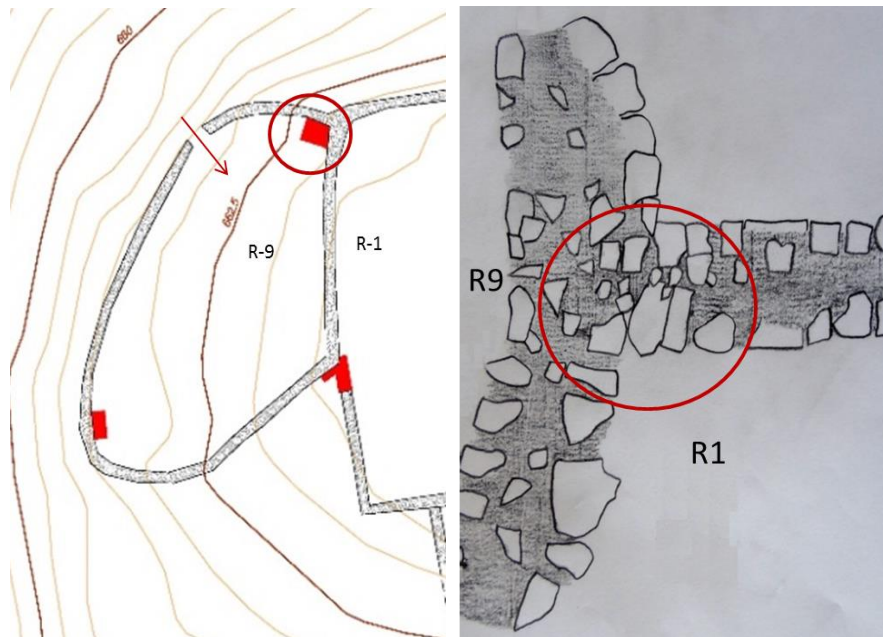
Detalles de plano topográfico y dibujo de planta sector unión R1 y R9 (Fuente: La Mura & Sánchez, 2017).
